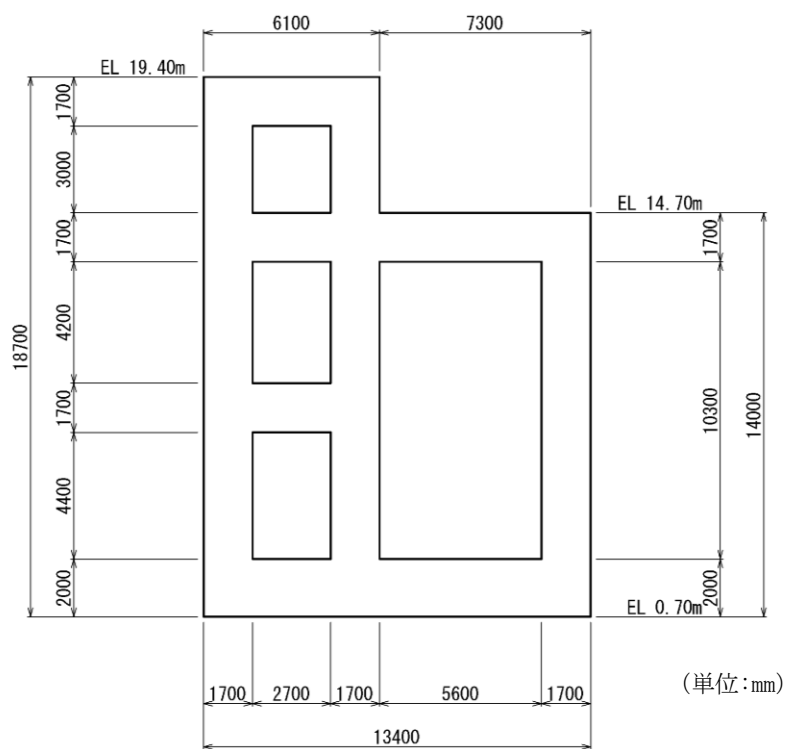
第 1 ベントフィルタ格納槽 断面図 (A-A 断面)
